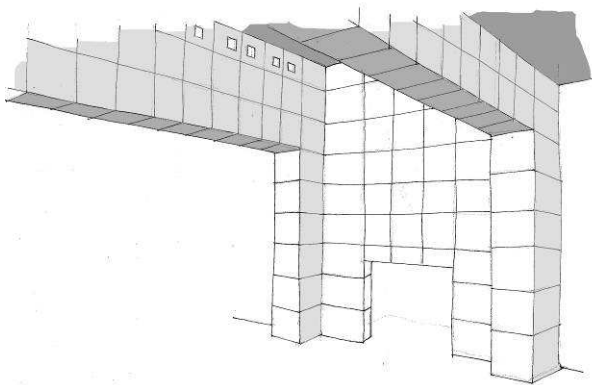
La cubierta de la Iglesia Unitaria está formada por un entramado de vigas de hormigón que se apoyan en los cuatro pilares principales interiores y en el sistema de columnas que definen el perímetro.
